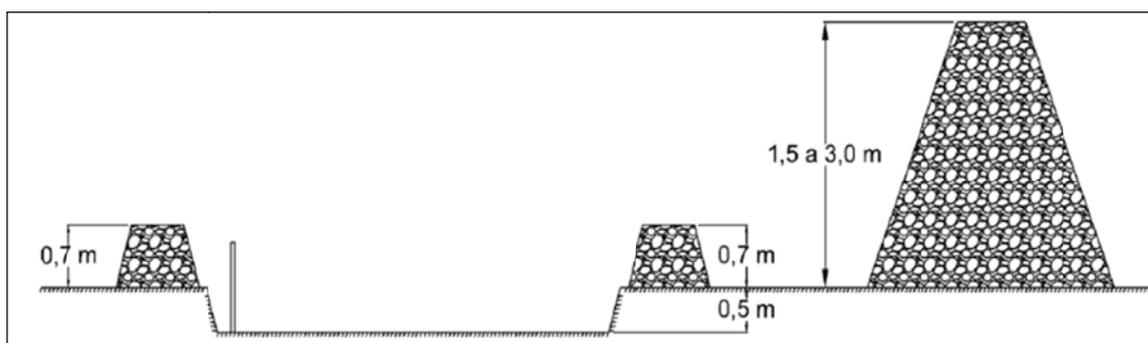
Corte esquemático de la construcción de balsas de infiltración
